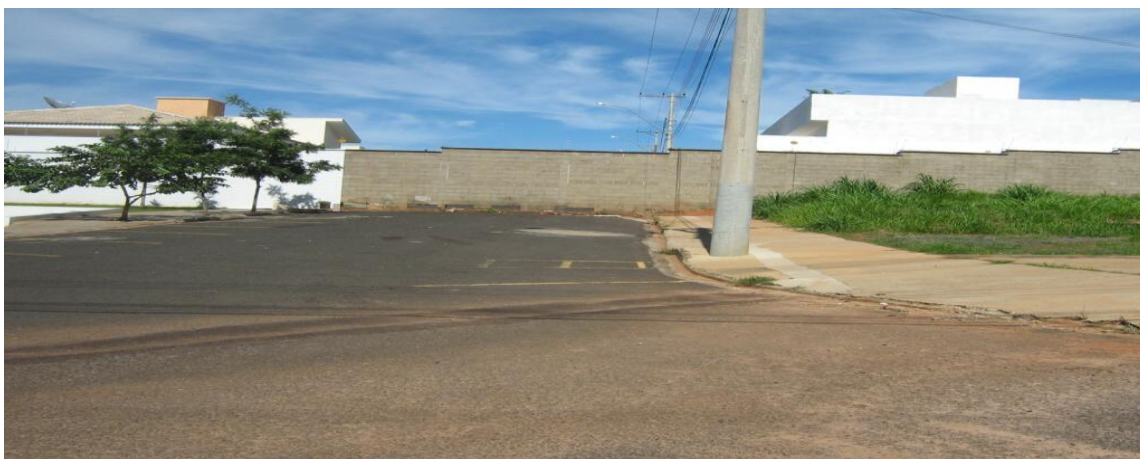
Rua fechada por muro do Jardim Vista Alegre (Figueira)
